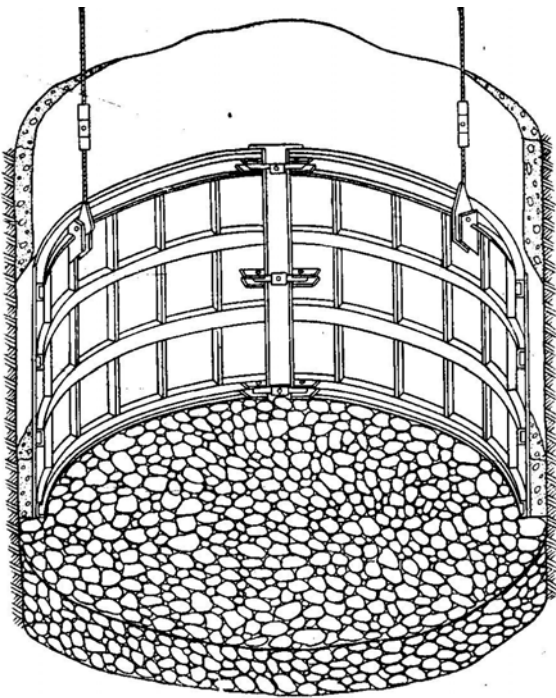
Опалубка секційна без жорсткого каркаса (ОС)
